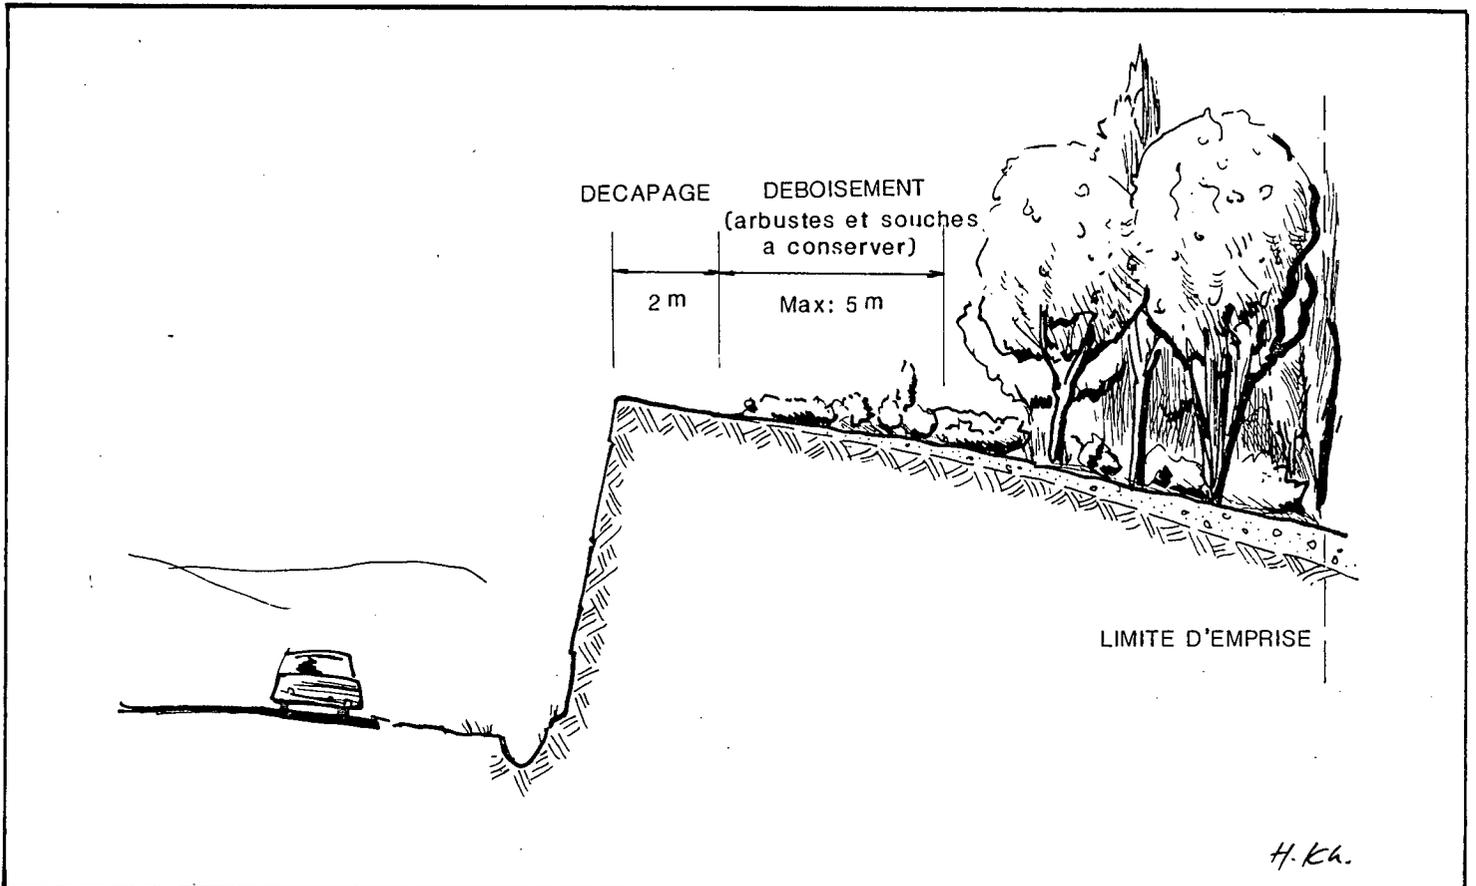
DEBOISEMENT DU HAUT D'UNE COUPE DE ROC SANS FOSSE DE DRAINAGE
